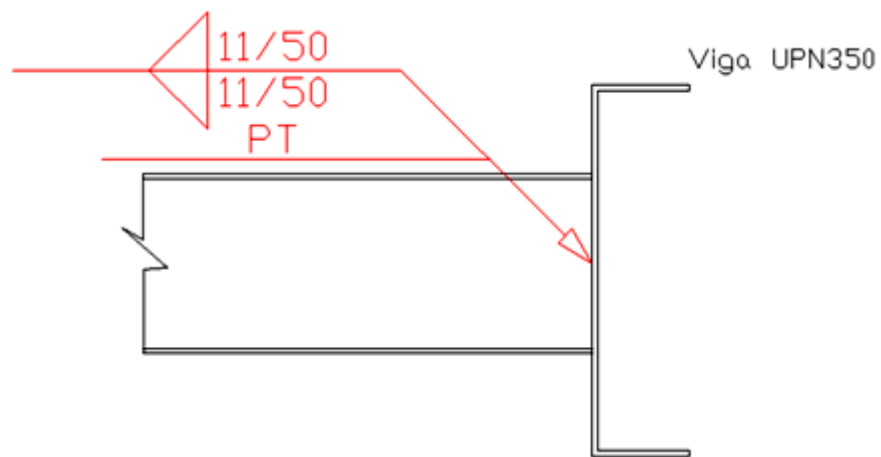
UNION DE VIGA IPN220-A/O A VIGA UPN350
